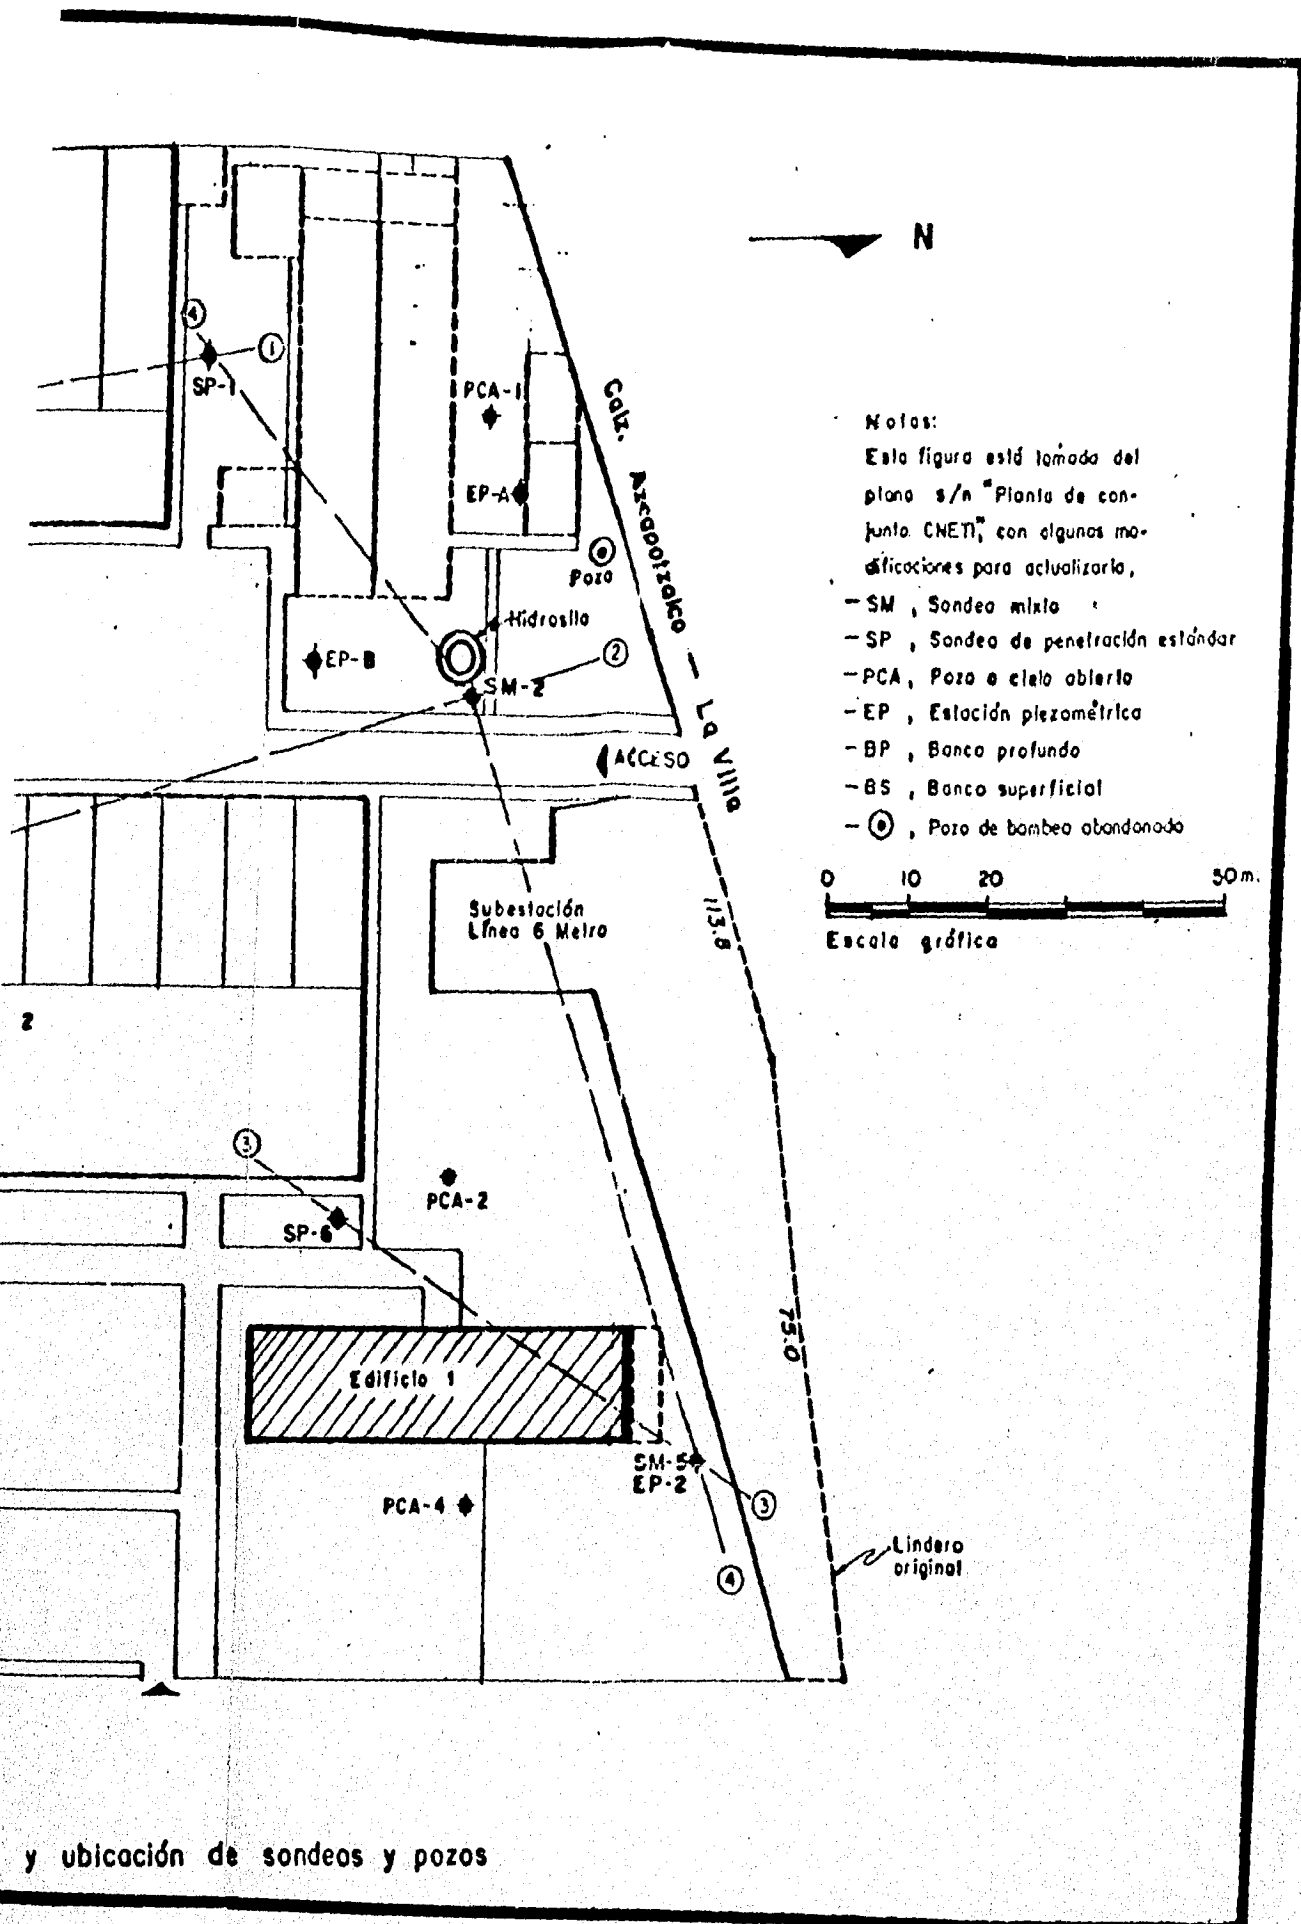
Planta de conjunto y ubicación de sondeos y pozos
